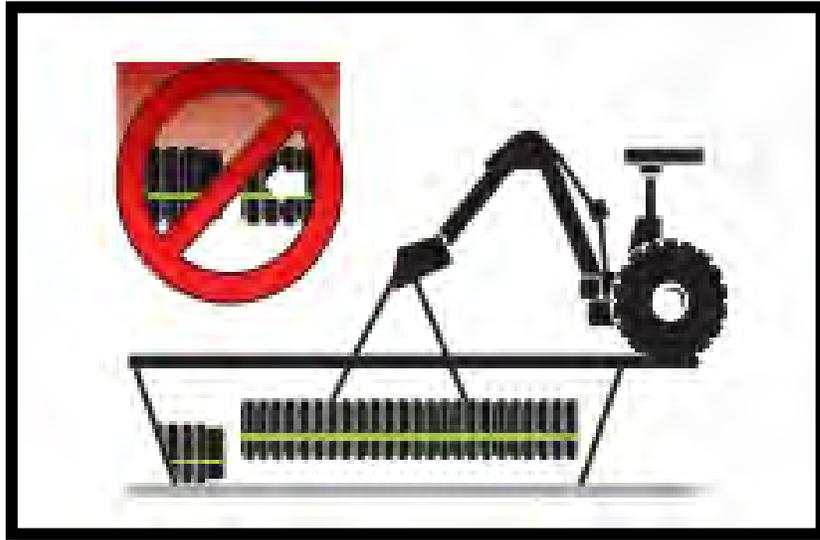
Instalación de tubería para drenaje sanitario ADS N-12 WT, (Ref. 18)
